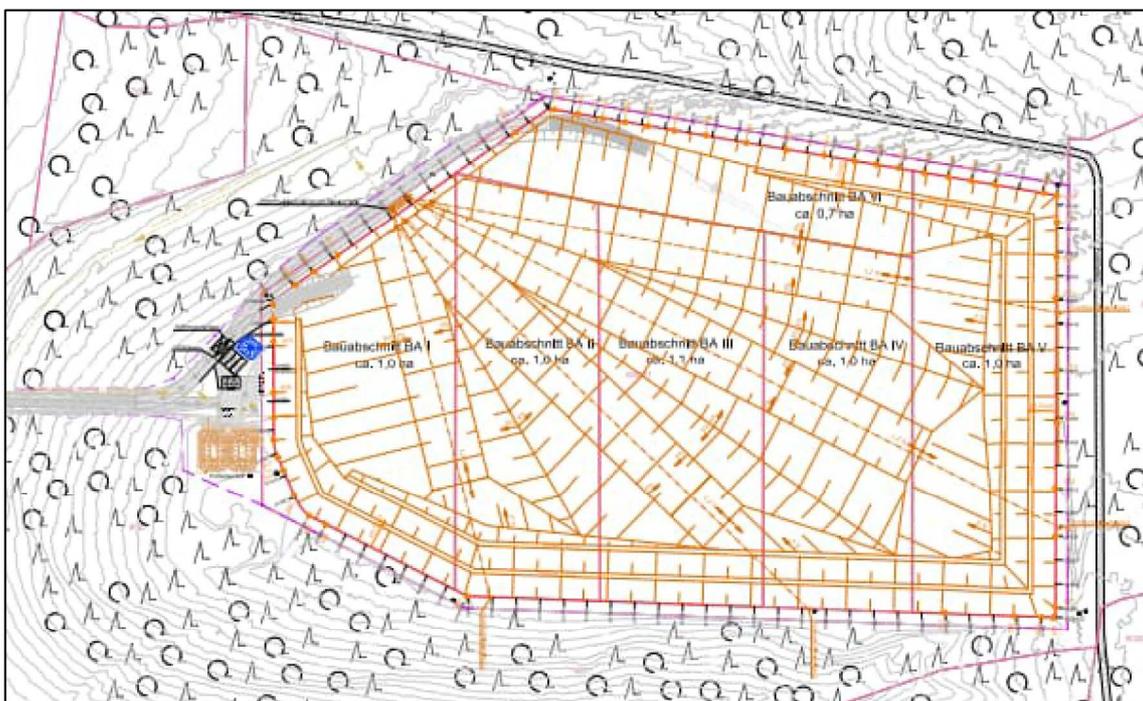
Lageplan der geplanten DKI-Deponie mit Verfüllabschnitten und Zufahrt
